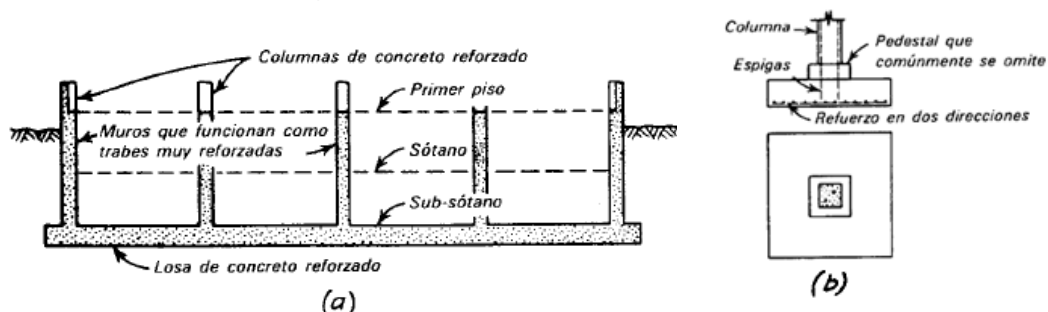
3: Fundaciones Directas (a) Losa de fundación, (b) Zapata aislada.
